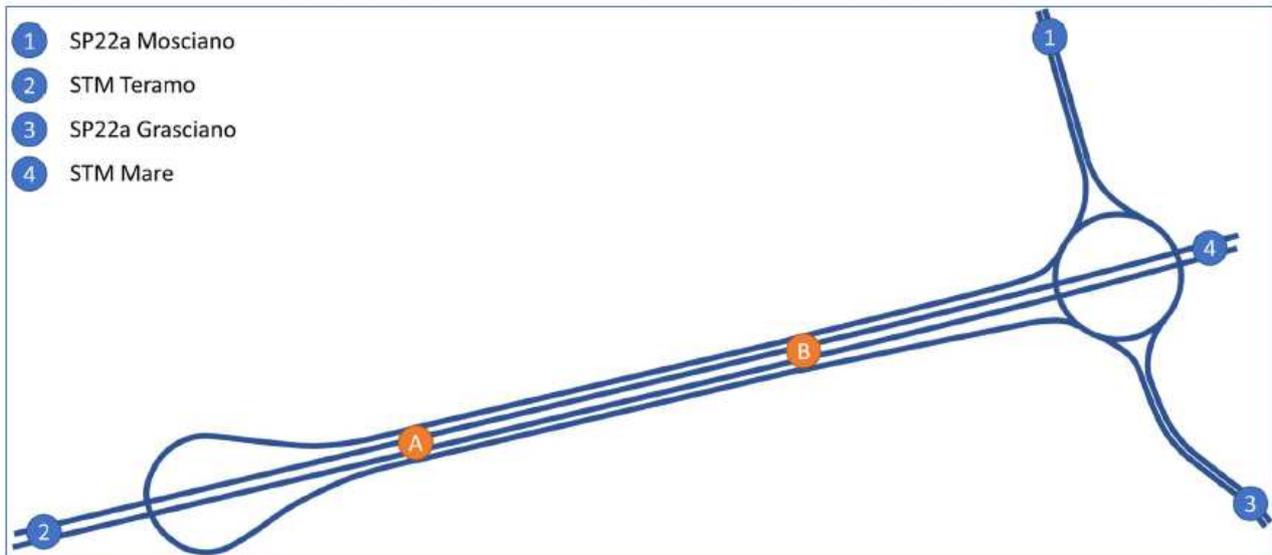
Configurazione schematica dello svincolo con attraversamento in viadotto
